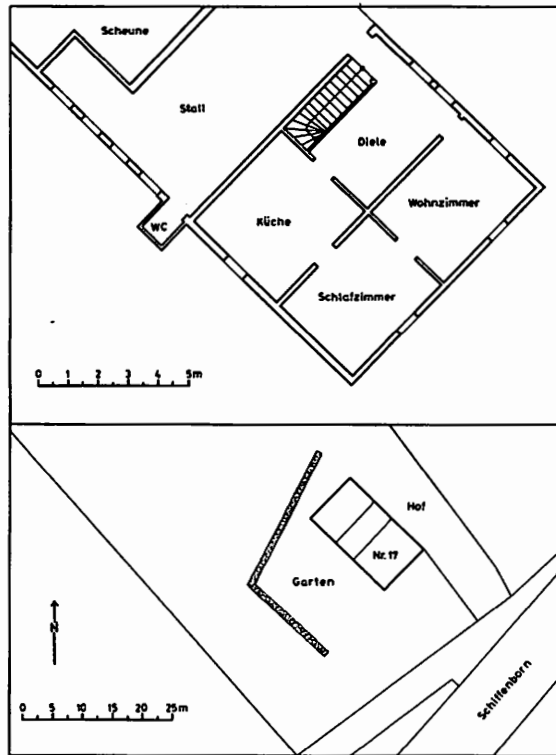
Lageplan und Erdgeschoßgrundriß des Gebäudes mit Haus-schutzhecke in Monschau-Mützenich, Schiffenborn 17 (gezeichnet nach der bei der Kreisverwaltung Aachen, Nebenstelle Monschau, vorliegenden Bauakte).
